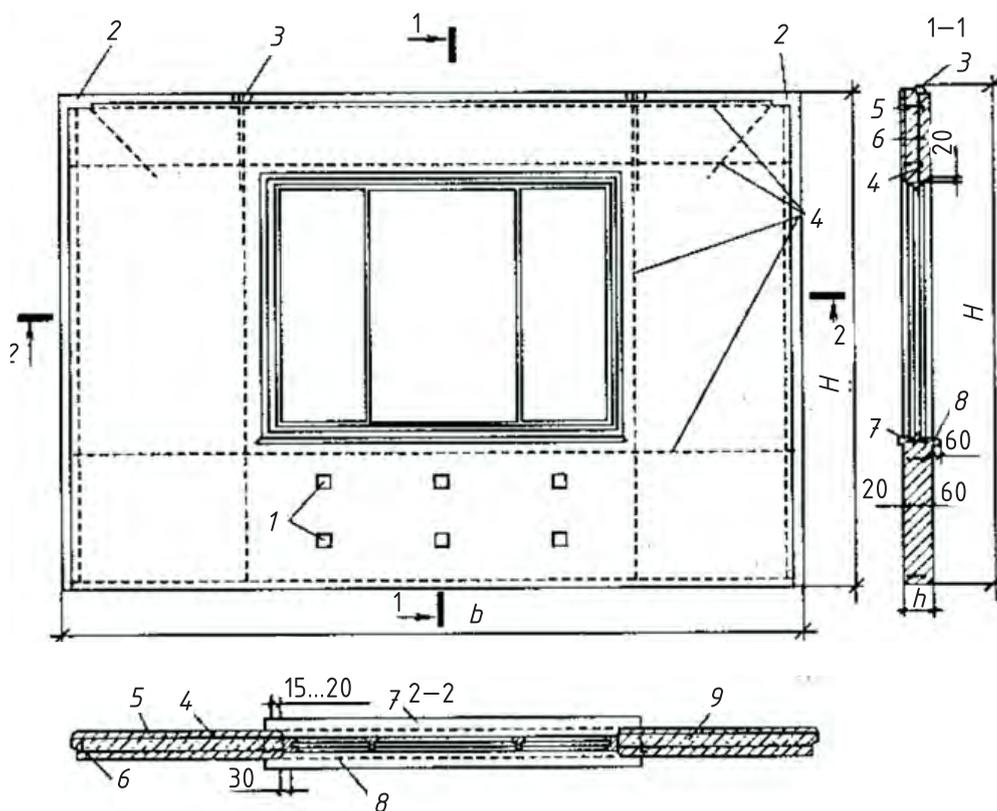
Двухслойная стеновая панель из легкого бетона: 1 — закладная деталь для крепления радиаторов; 2 — закладные детали; 3 — монтажные петли; 4 — арматурный каркас; 5 — отделочный слой; 6 — несущий слой; 7 — слив; 8 — подоконная доска; 9 — теплоизоляционный слой
